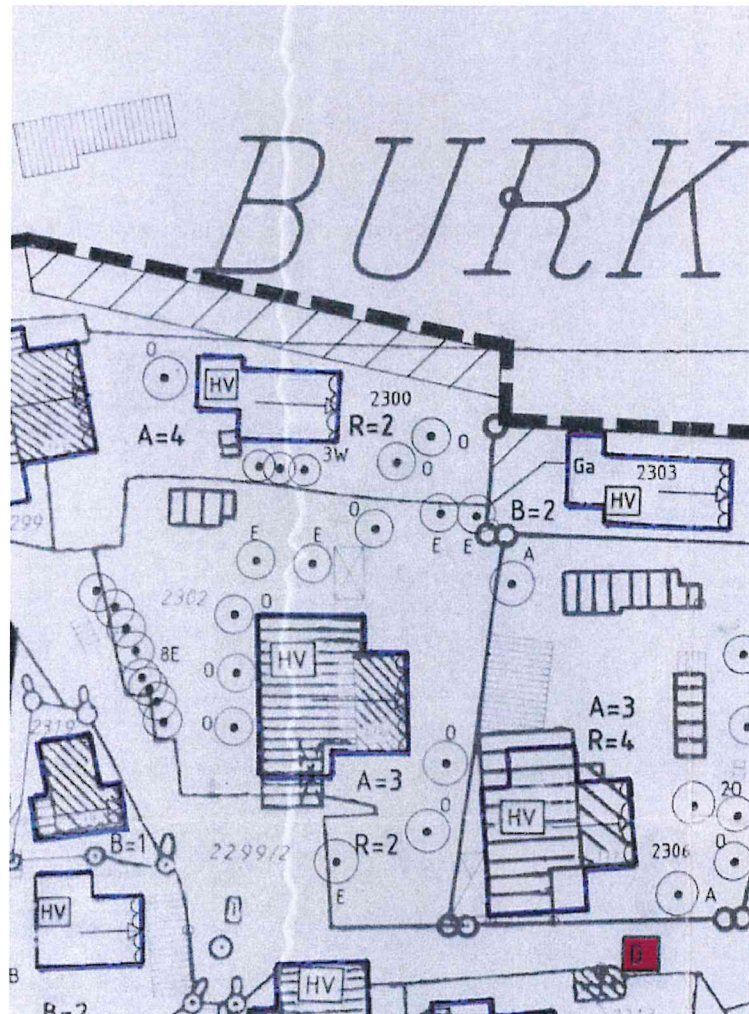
Lageplan des Bebauungsplanes „Burk“, unmaßstäblich
